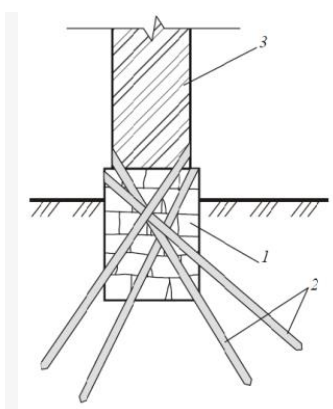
Усиление фундаментов буринъекционными сваями: 1-фундамент, 2-буринъекционные сваи, 3-стена
